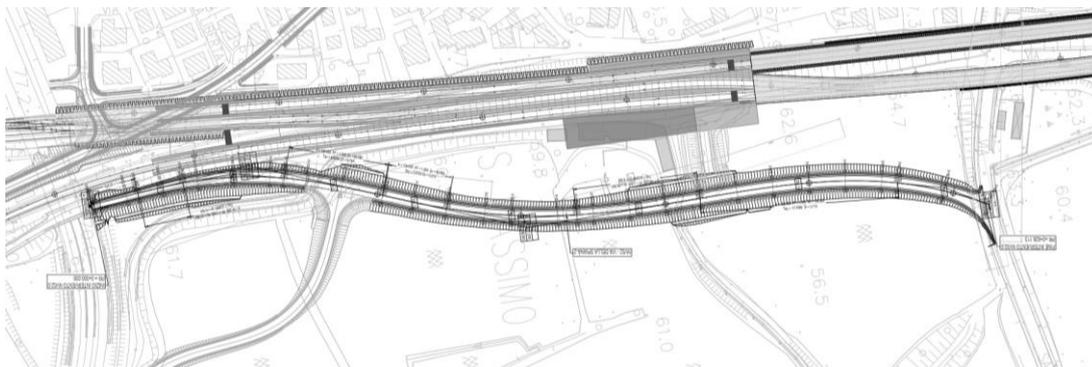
Stralcio planimetrico su rilievo Via della Spianà temporanea.
